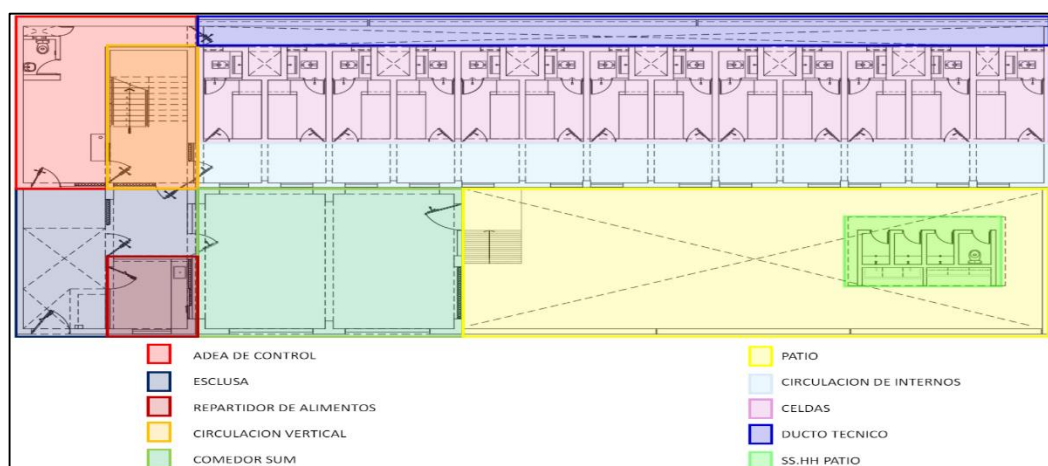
Planta 1er piso del pabellón máxima - Varones
